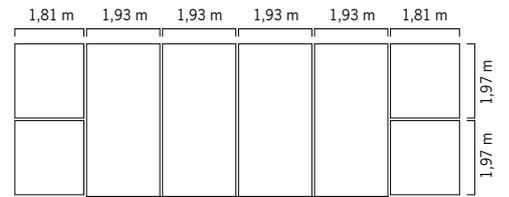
Planta da camada de polietileno Superior - 1/150
